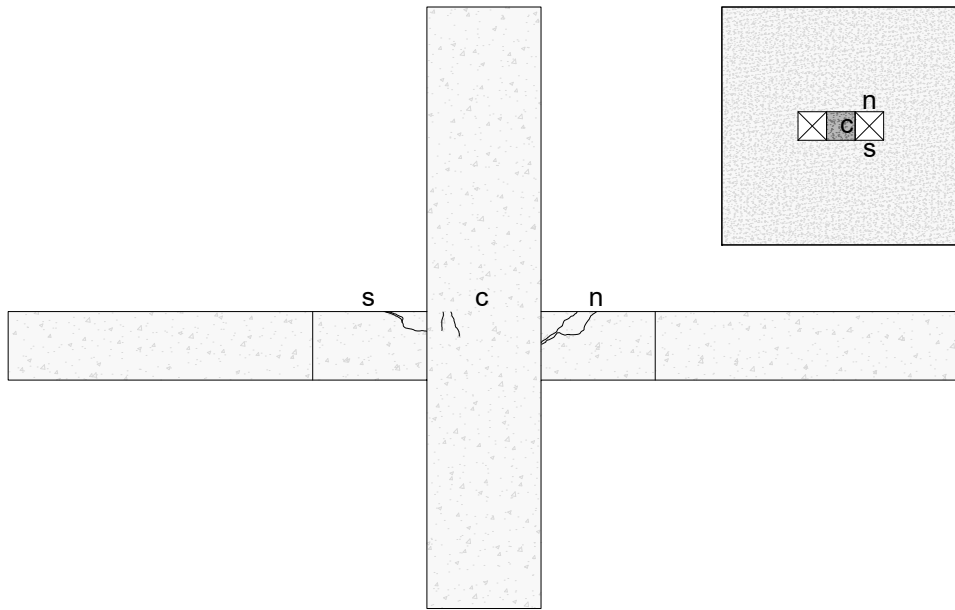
Padrão de fissuração da laje LFE3 - vistas abertura
